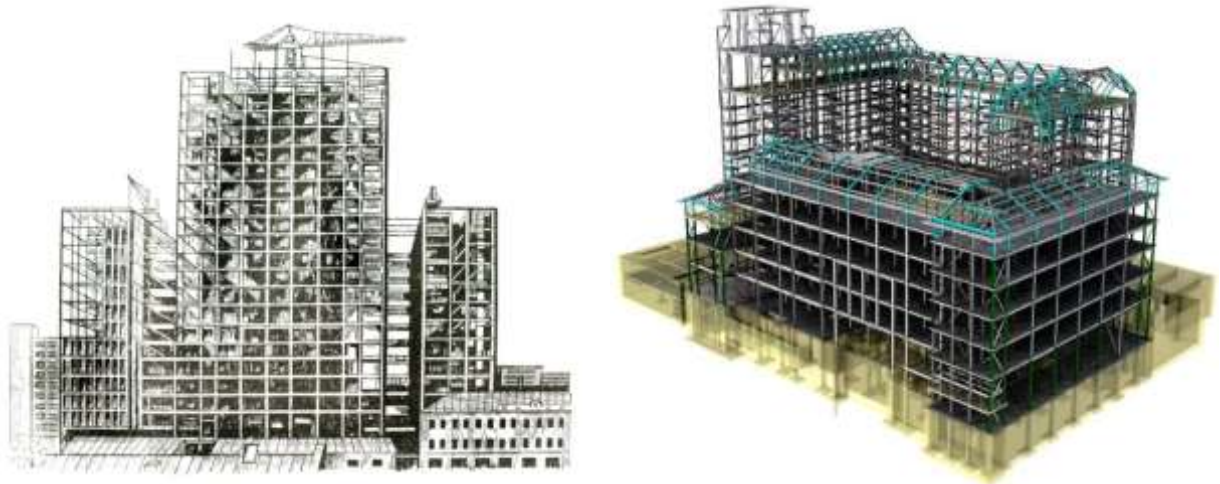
Сталевий каркас багатопверхової житлової будівлі в умовах щільної забудови
